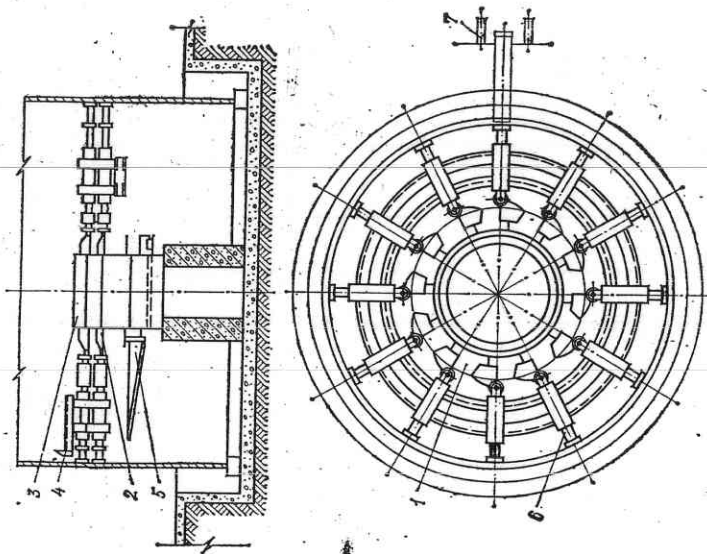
Кулачковый механизированный стэнд для сборки звеньев:
